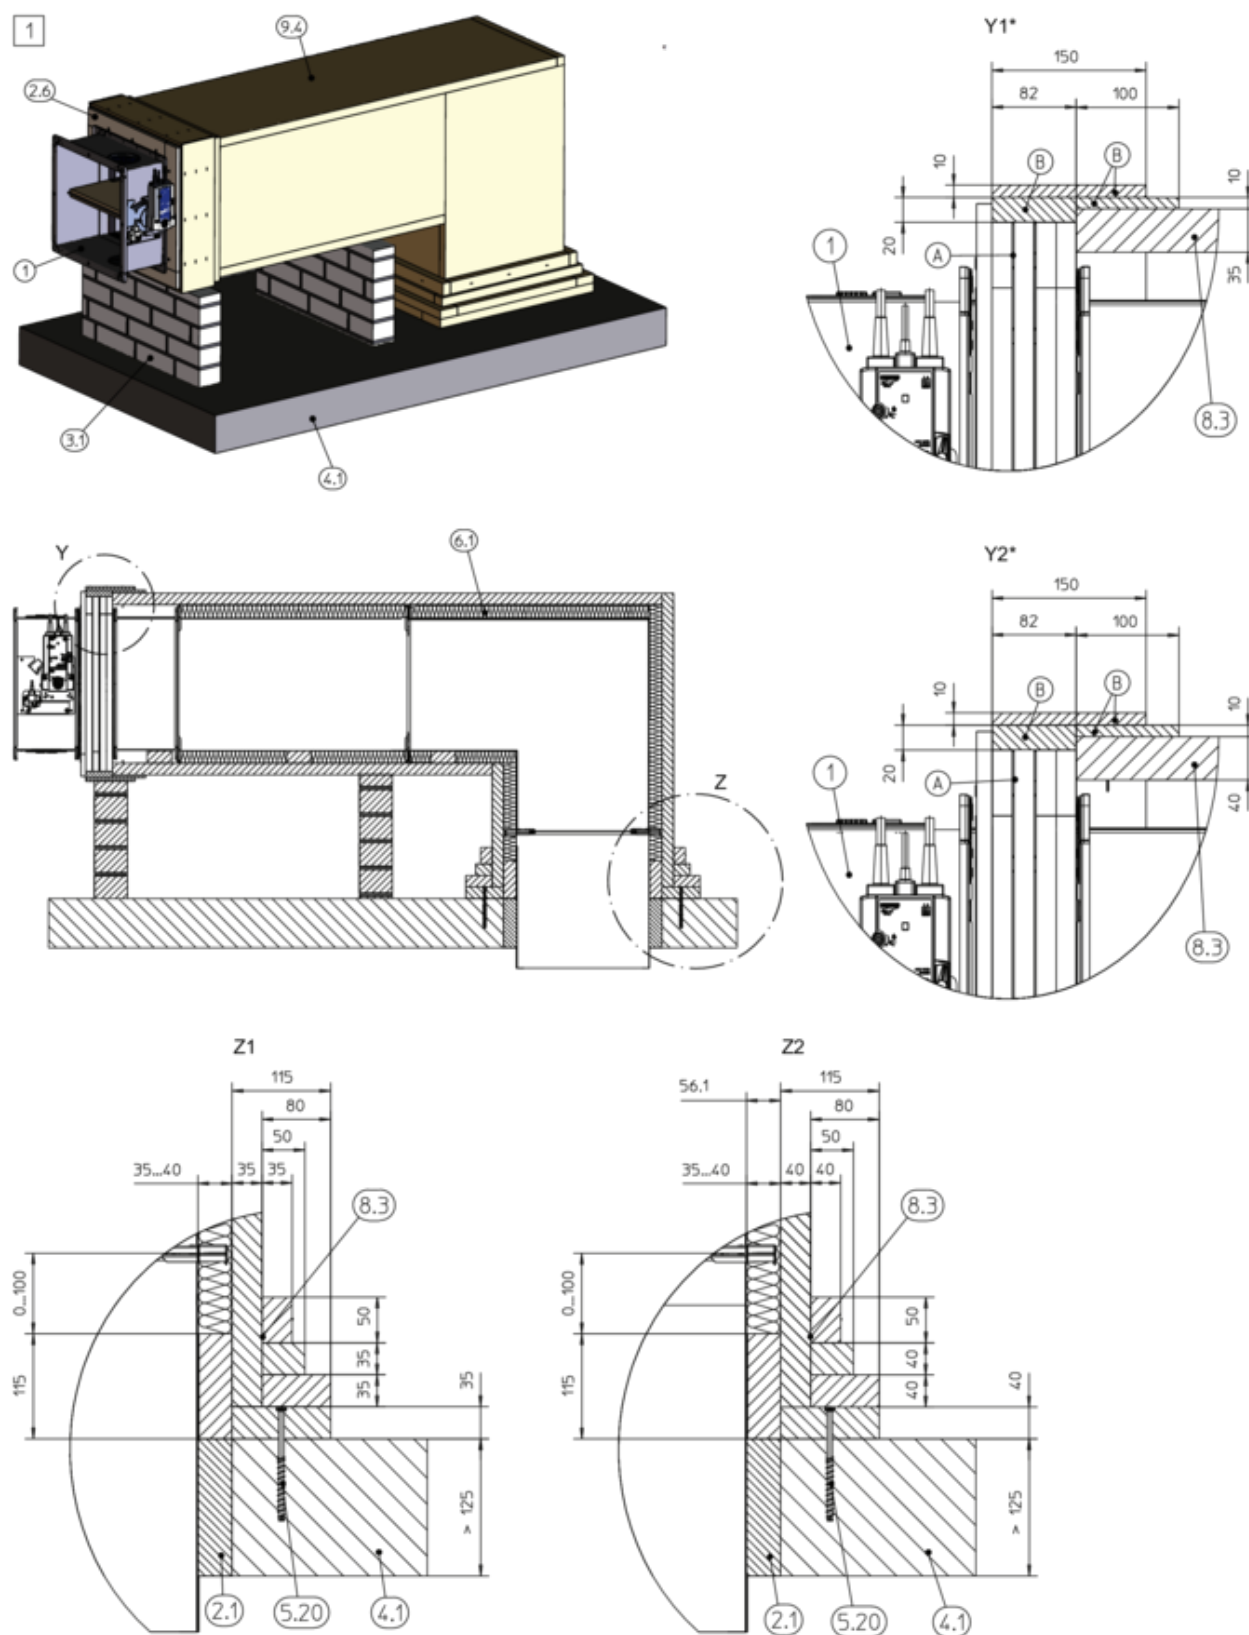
Montage à sec sans mortier à distance de dalles de plafond pleines, avec kit de montage WE, illustré par Fig. 178
